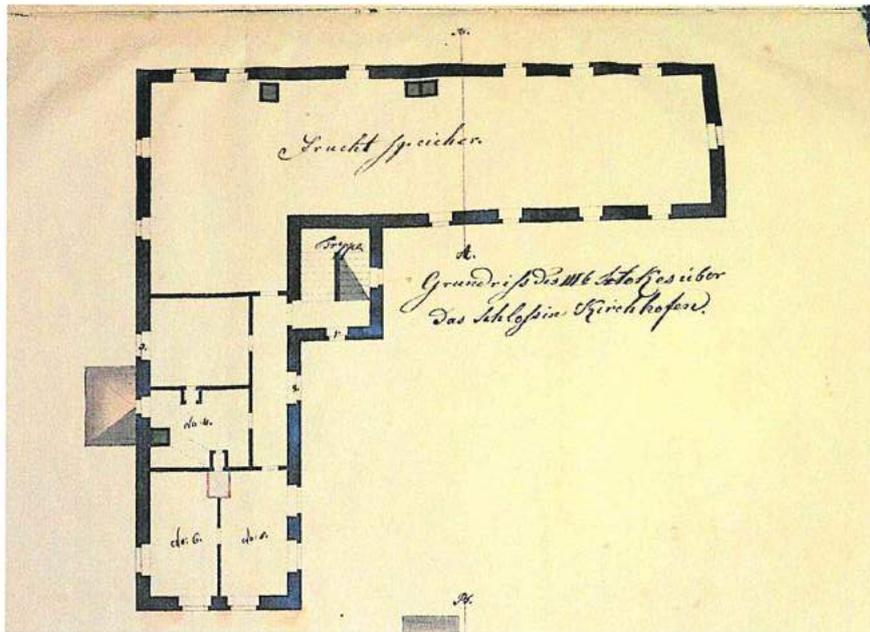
Grundriss des IIIten Stockes über Das Schloss Kirchhofen,
